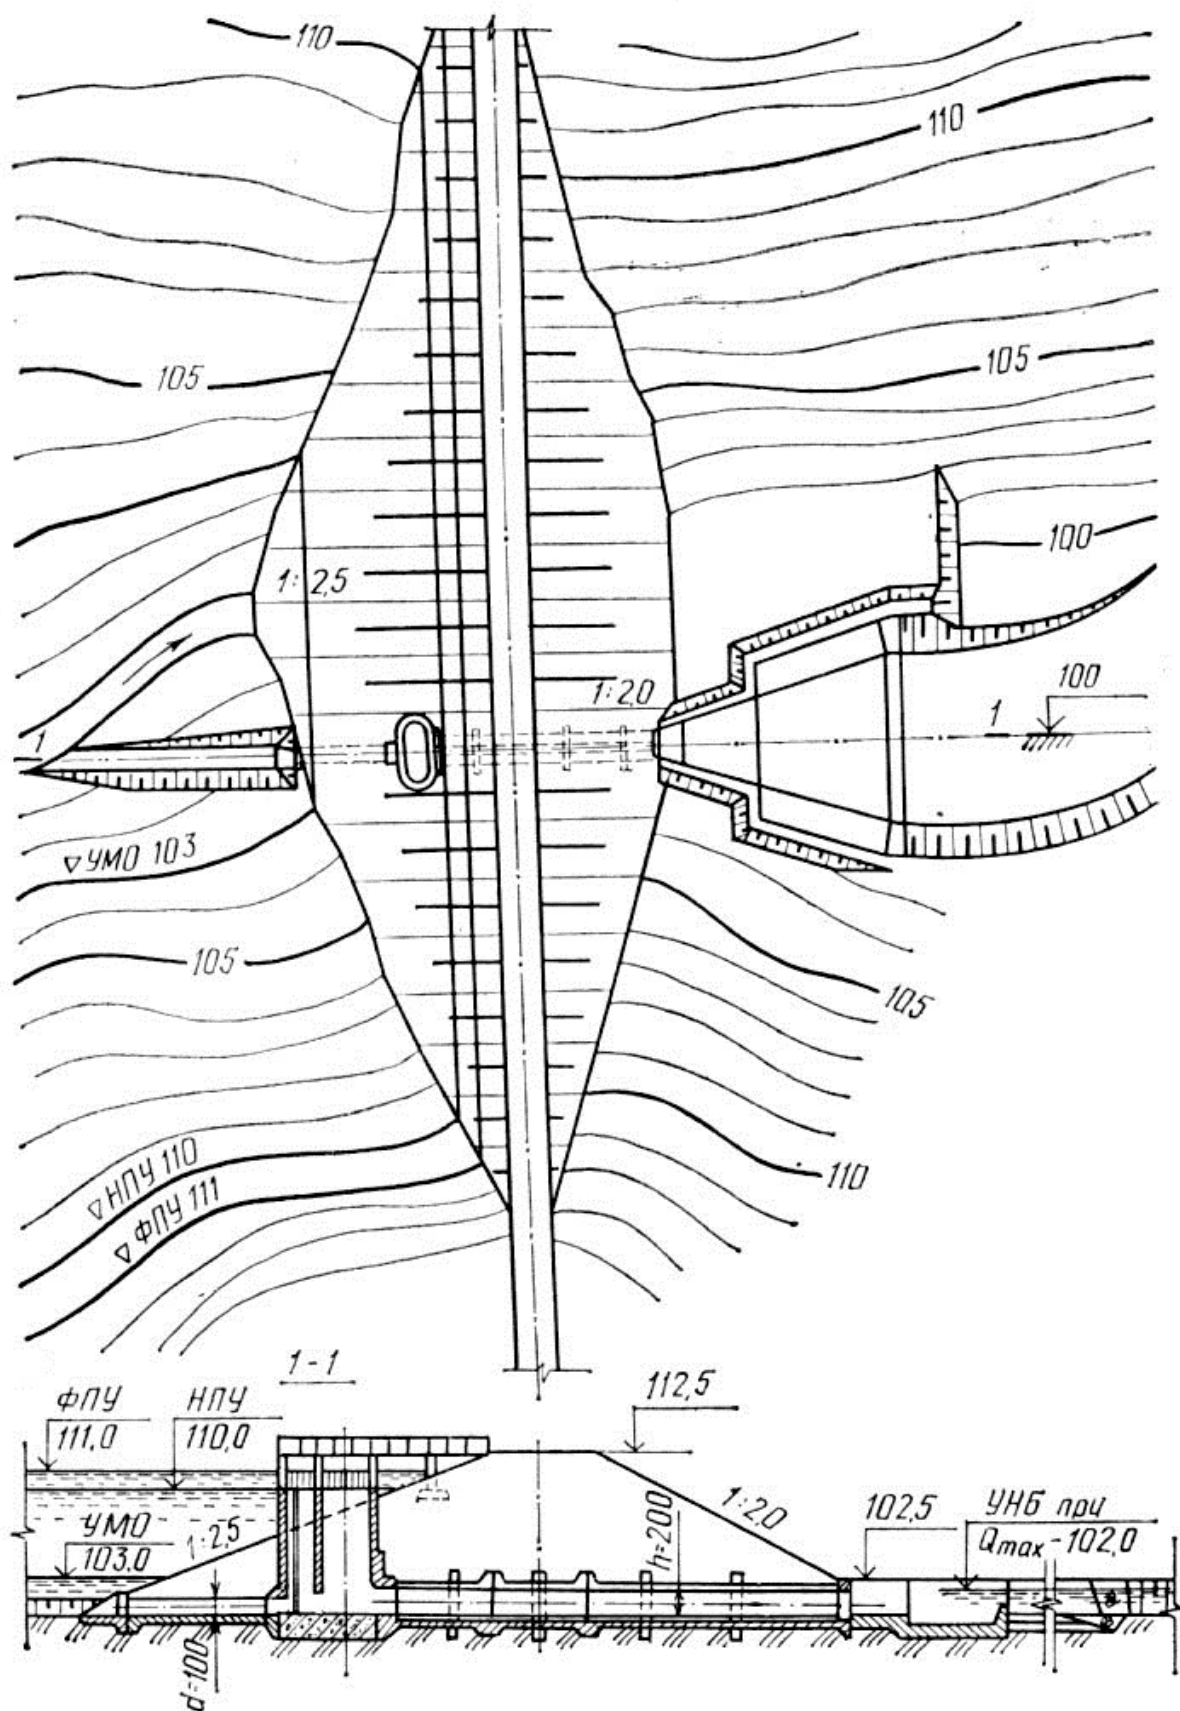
Схема гидроузла с шахтным водосбросом-водовыпуском
